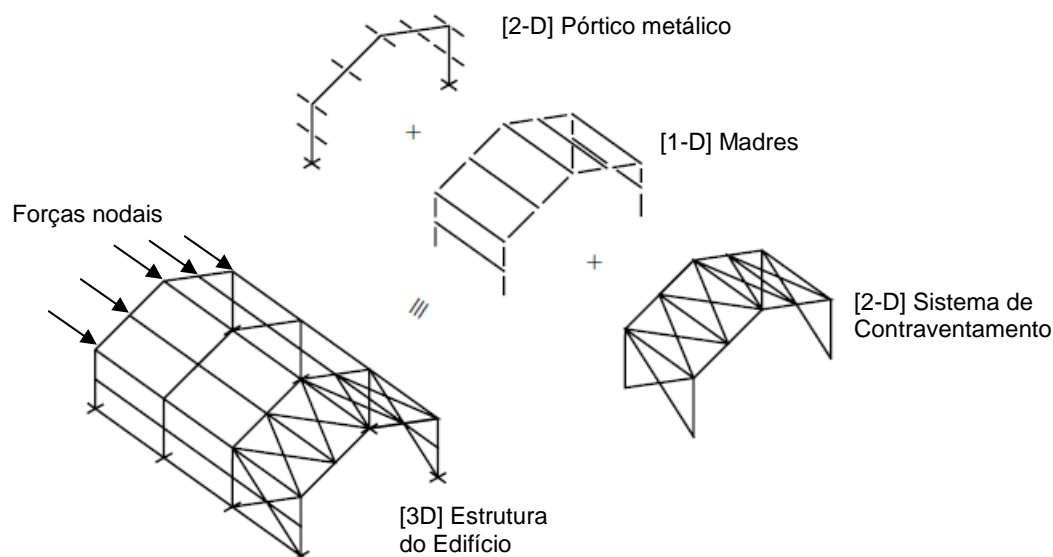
Esquema estrutural de um edifício metálico de um piso (adaptado de Trahair *et al*, 2008)
